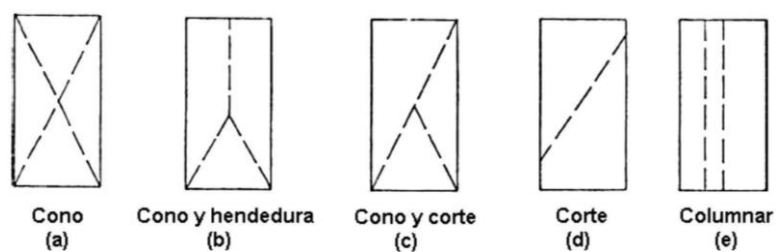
44. Tipos de fallas en probetas estándar de concreto.
